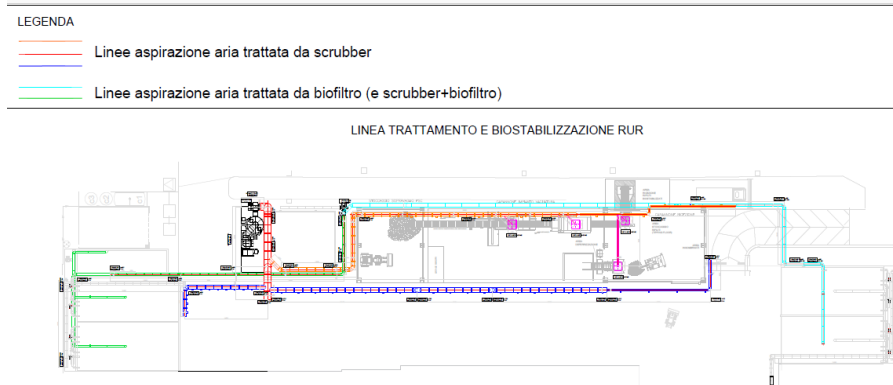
stralcio estratto da Tav.11 rev.02 "Planimetria progetto rete impiantistica trattamento arie"
